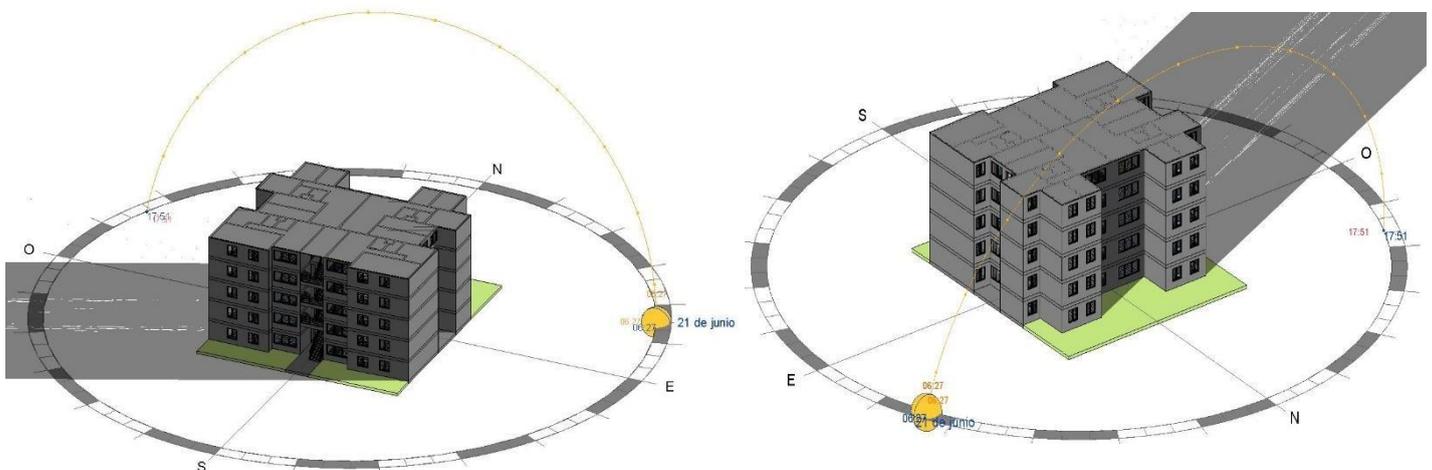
Asoleamiento fachada sur-este (ver lámina L-03)
